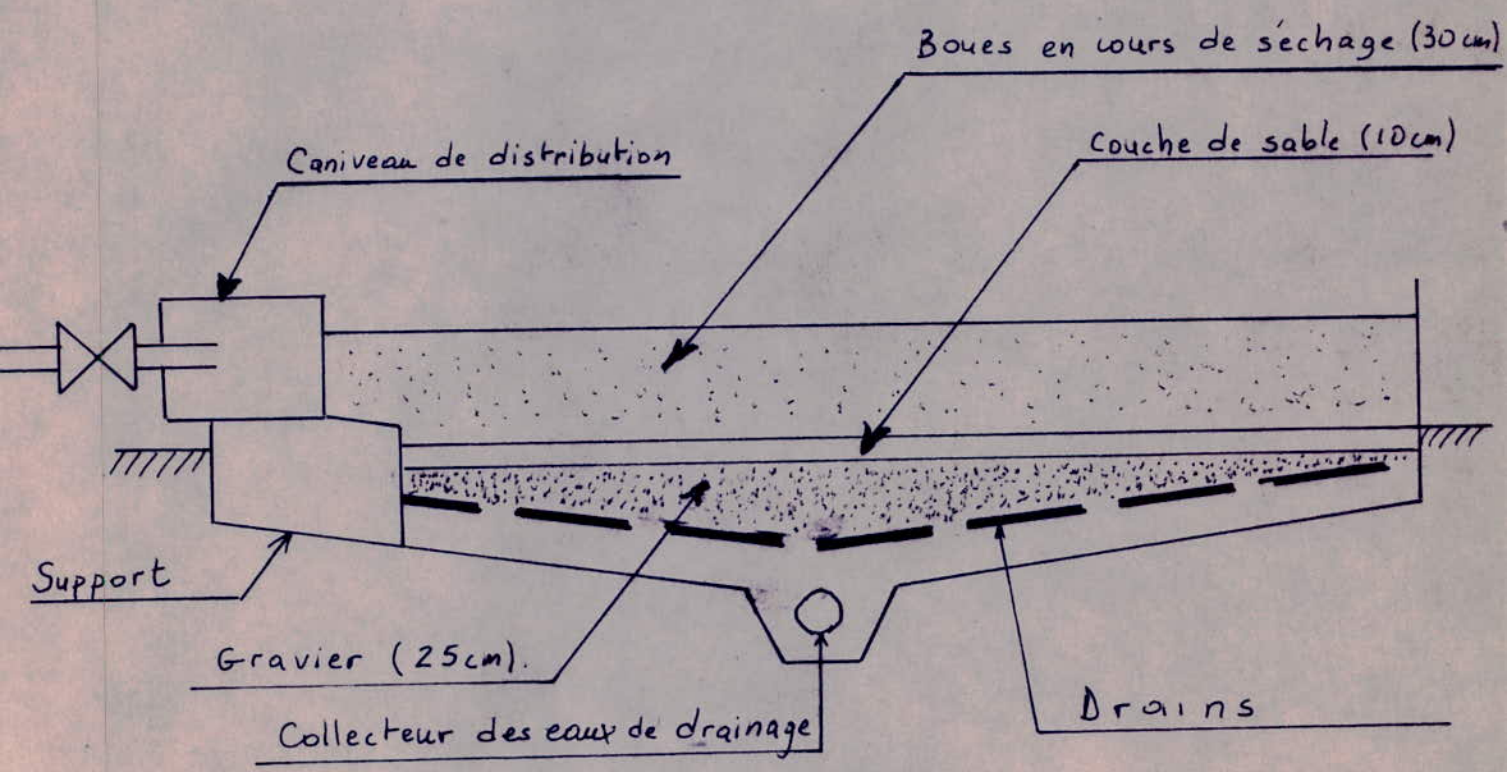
b - Coupe longitudinale d'un lit de séchage
